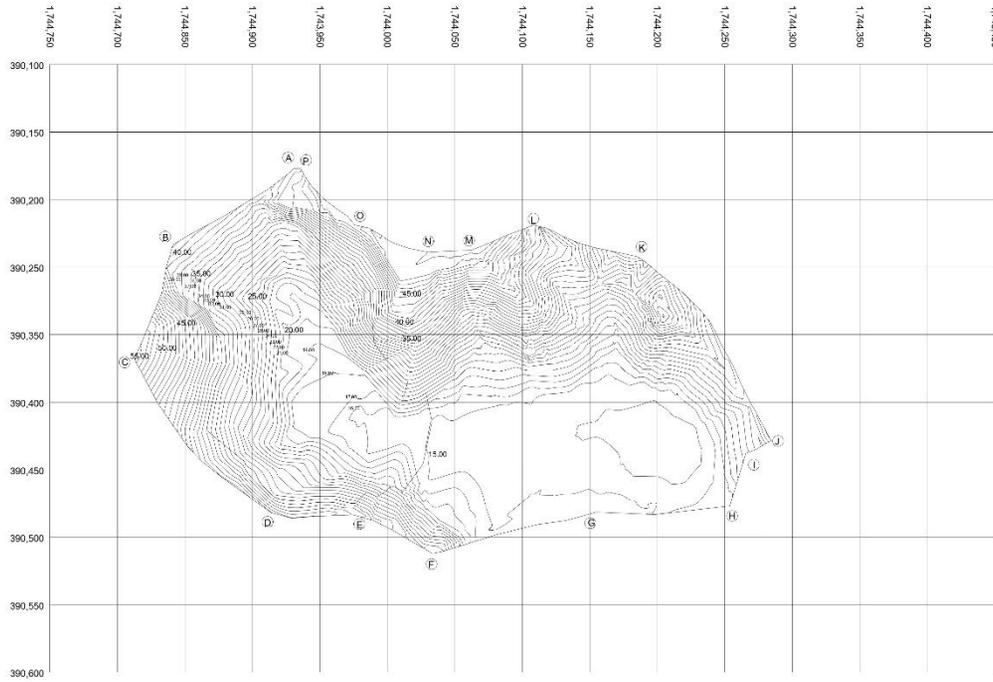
Plano 03 de Detalle y Ubicación de chimenea del año 2016
